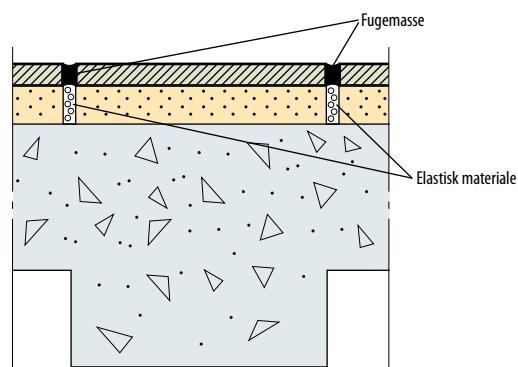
Bevegelsesfuger på begge sider av betongbjelke i underkonstruksjon.
